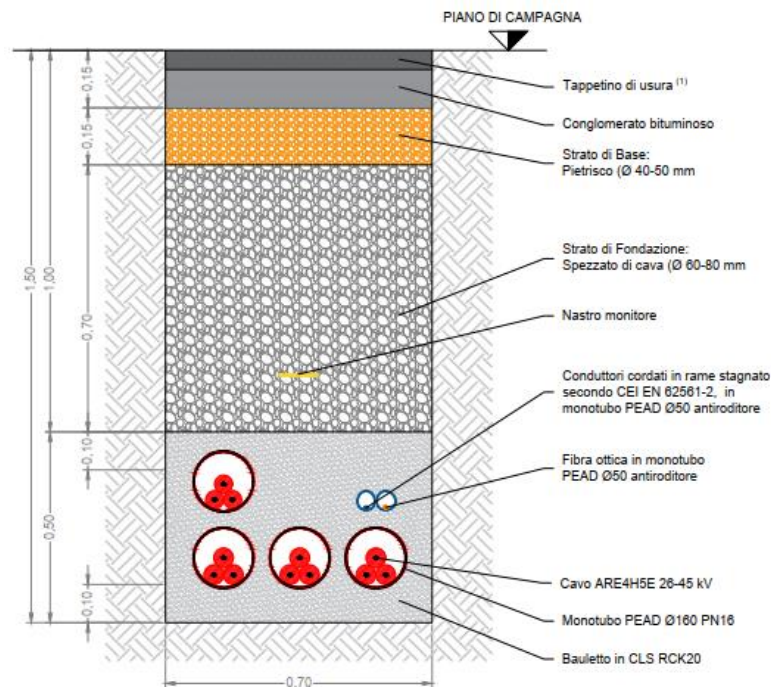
sezione stradale cavidotto di connessione a SSEU
